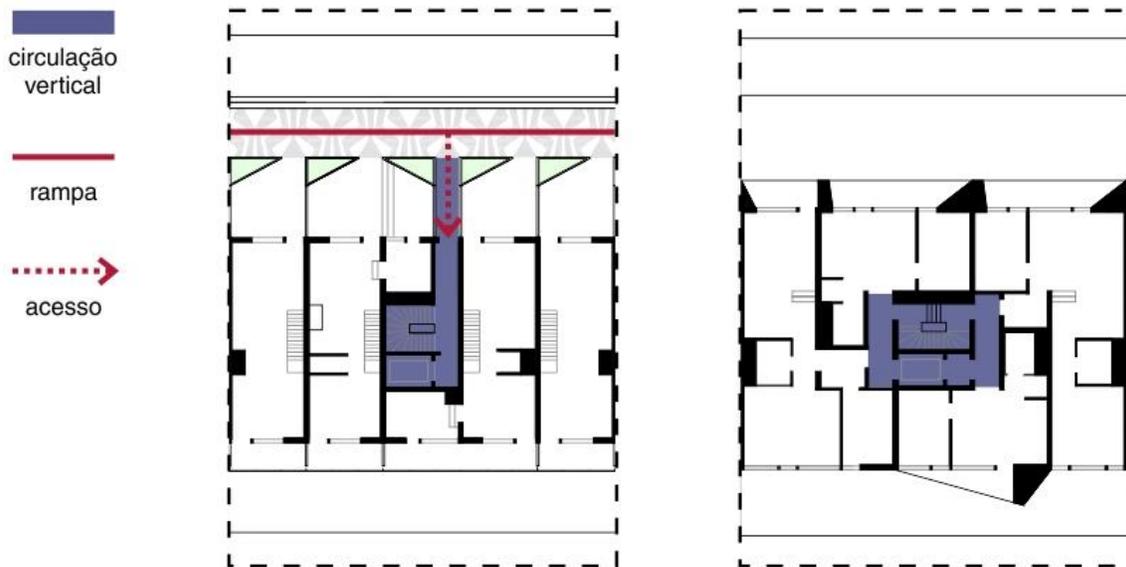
| 8 House - Circulações verticais, plantas nível rampa e nível intermed. | Desenho da autora
